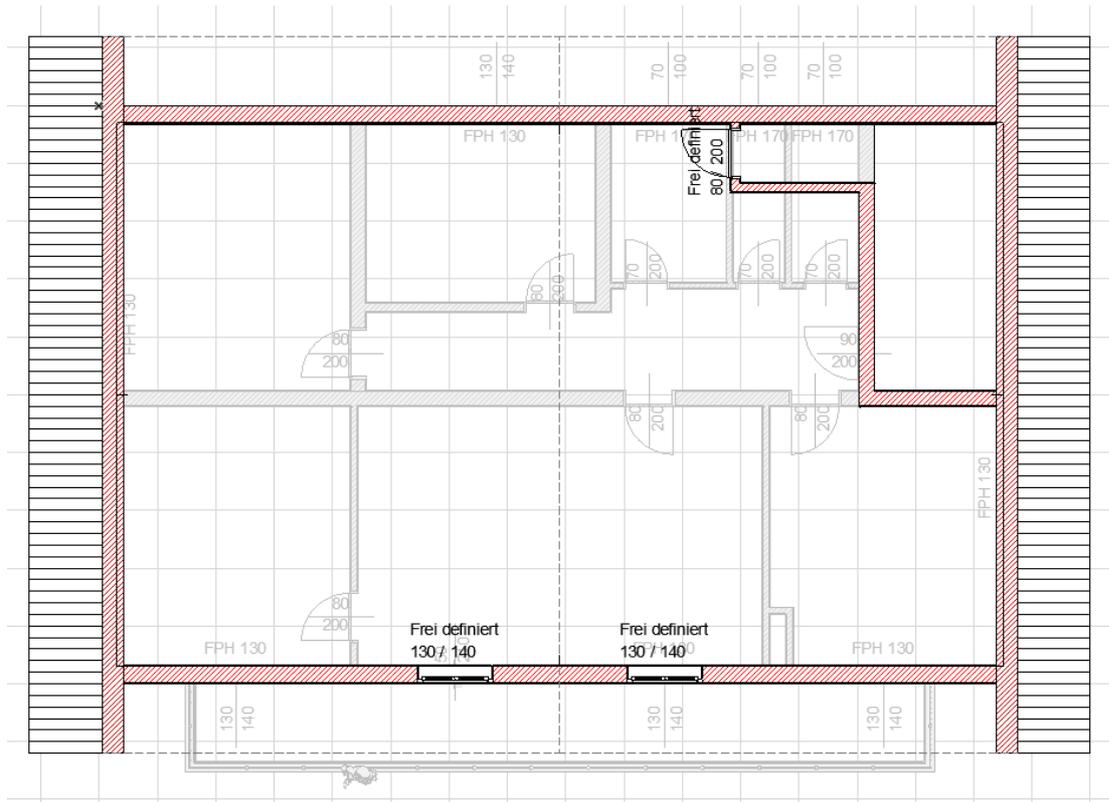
Grundriss Bestandsgebäude Dachgeschoss [50]
